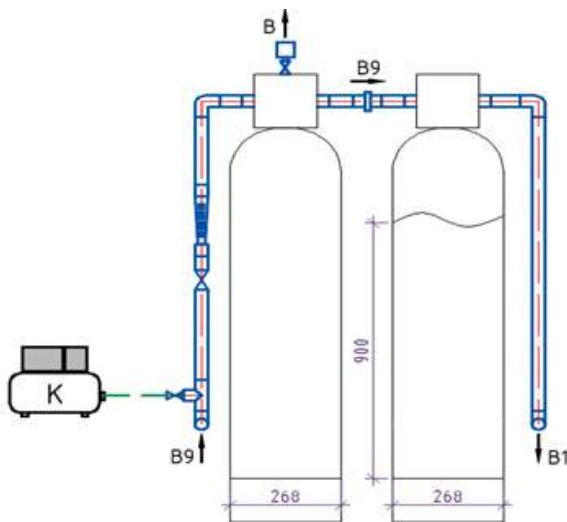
Схема установки для проведения пробного обезжелезивания
